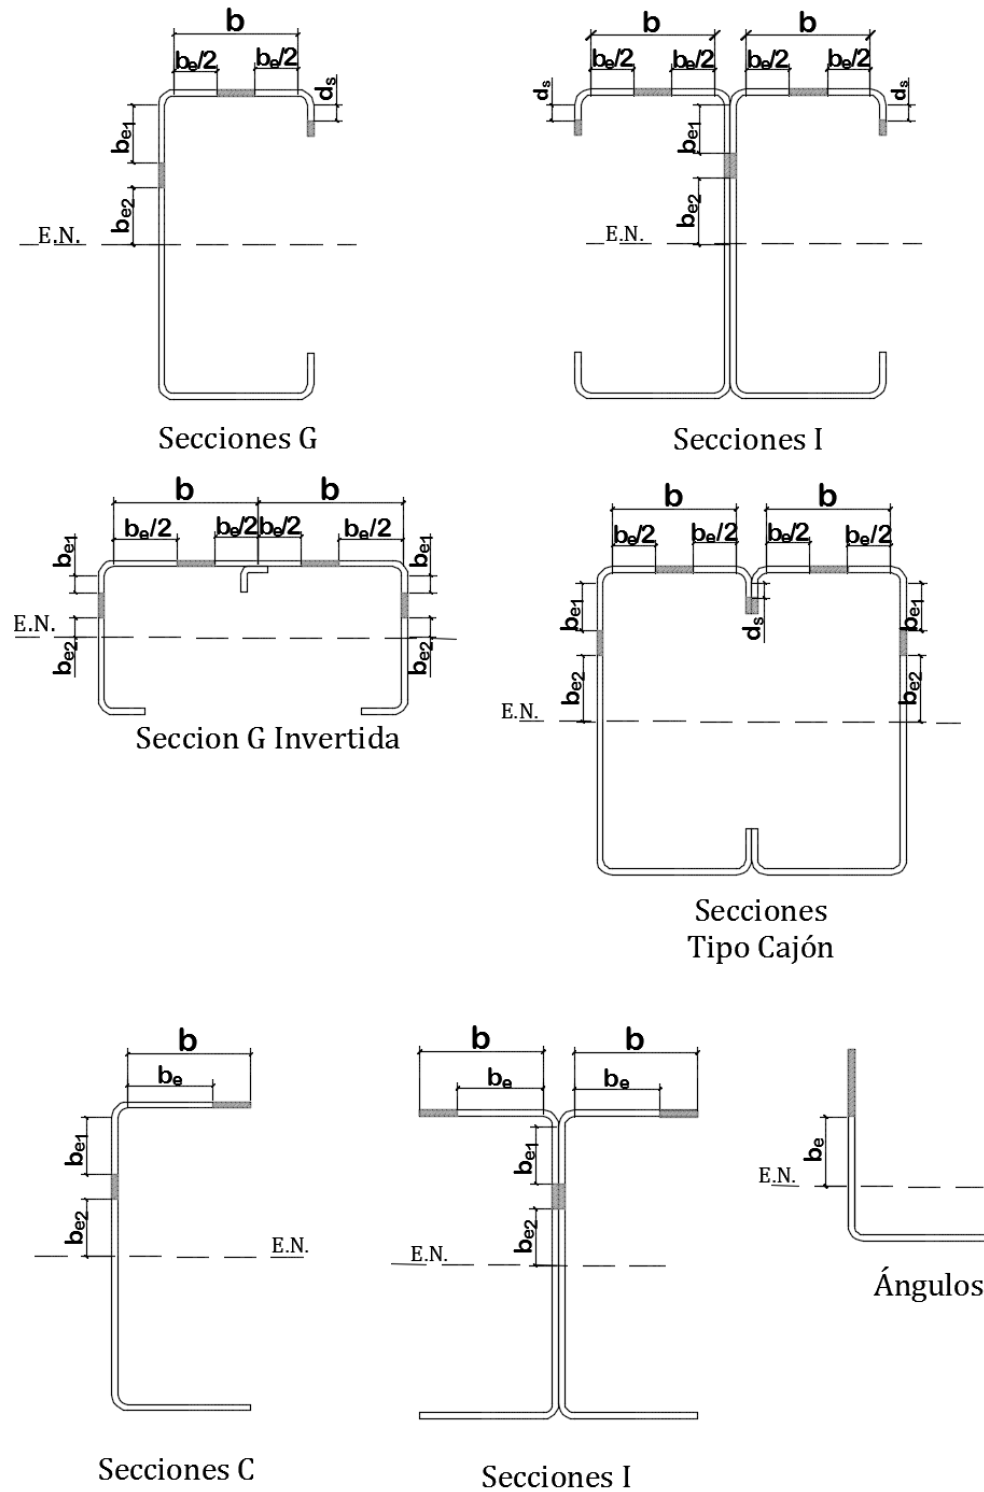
Anchos efectivos de los Perfiles Doblados en Frío
